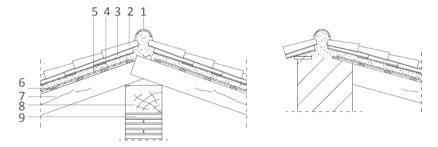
Detalle cumbrera: 1)Cumbrera teja árabe; 2)Teja cobija; 3)Teja canal; 4)Mortero de agarre; 5)Ladrillo cerámico; 6)Rastrel; 7)Vigueta de madera; 8)Viga de madera; 9)Pilar de ladrillo cerámico. 2015. Fuente propia
